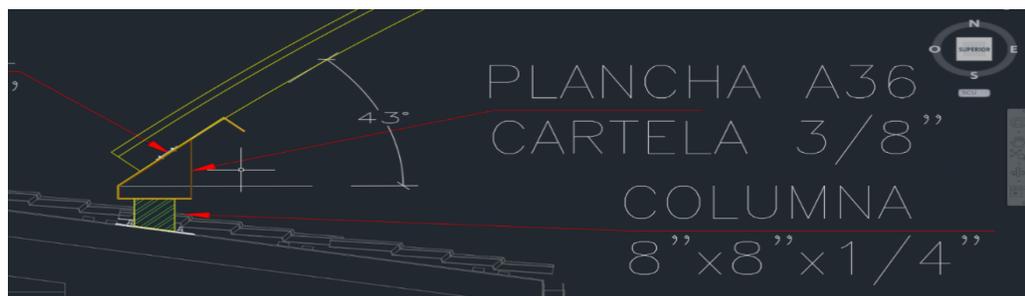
Detalle de plancha soldada a tubo cuadrado
